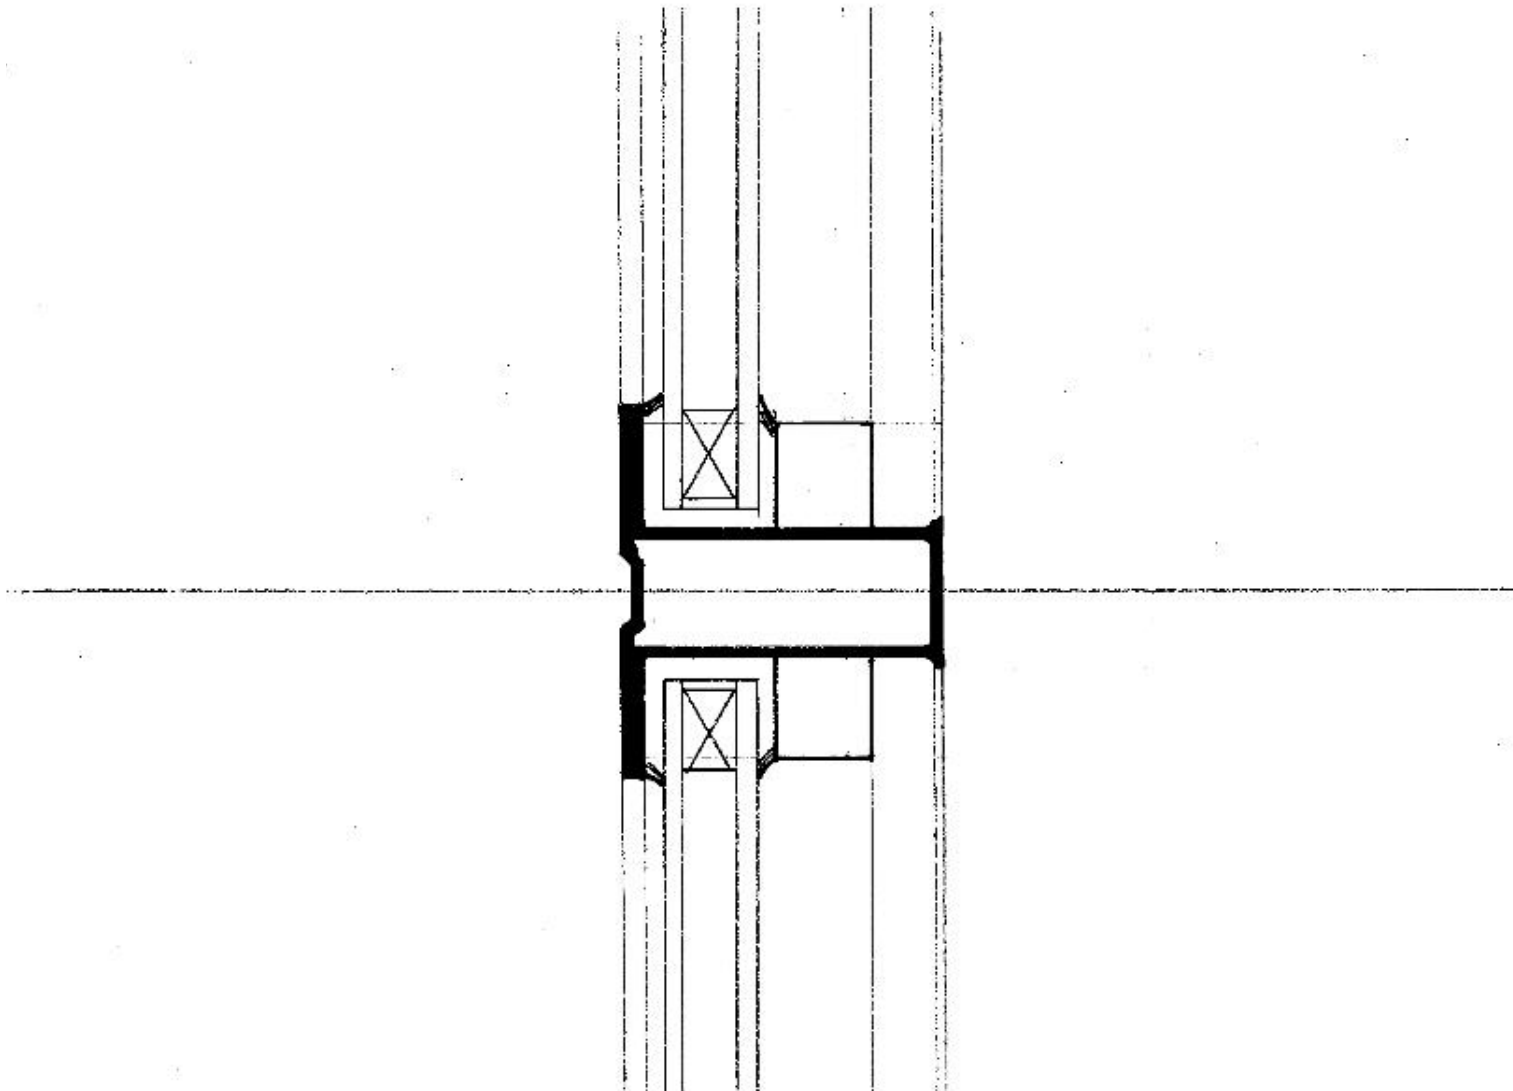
Fensterdetail der Flurzone neu, mit Wärmeschutzverglasung
